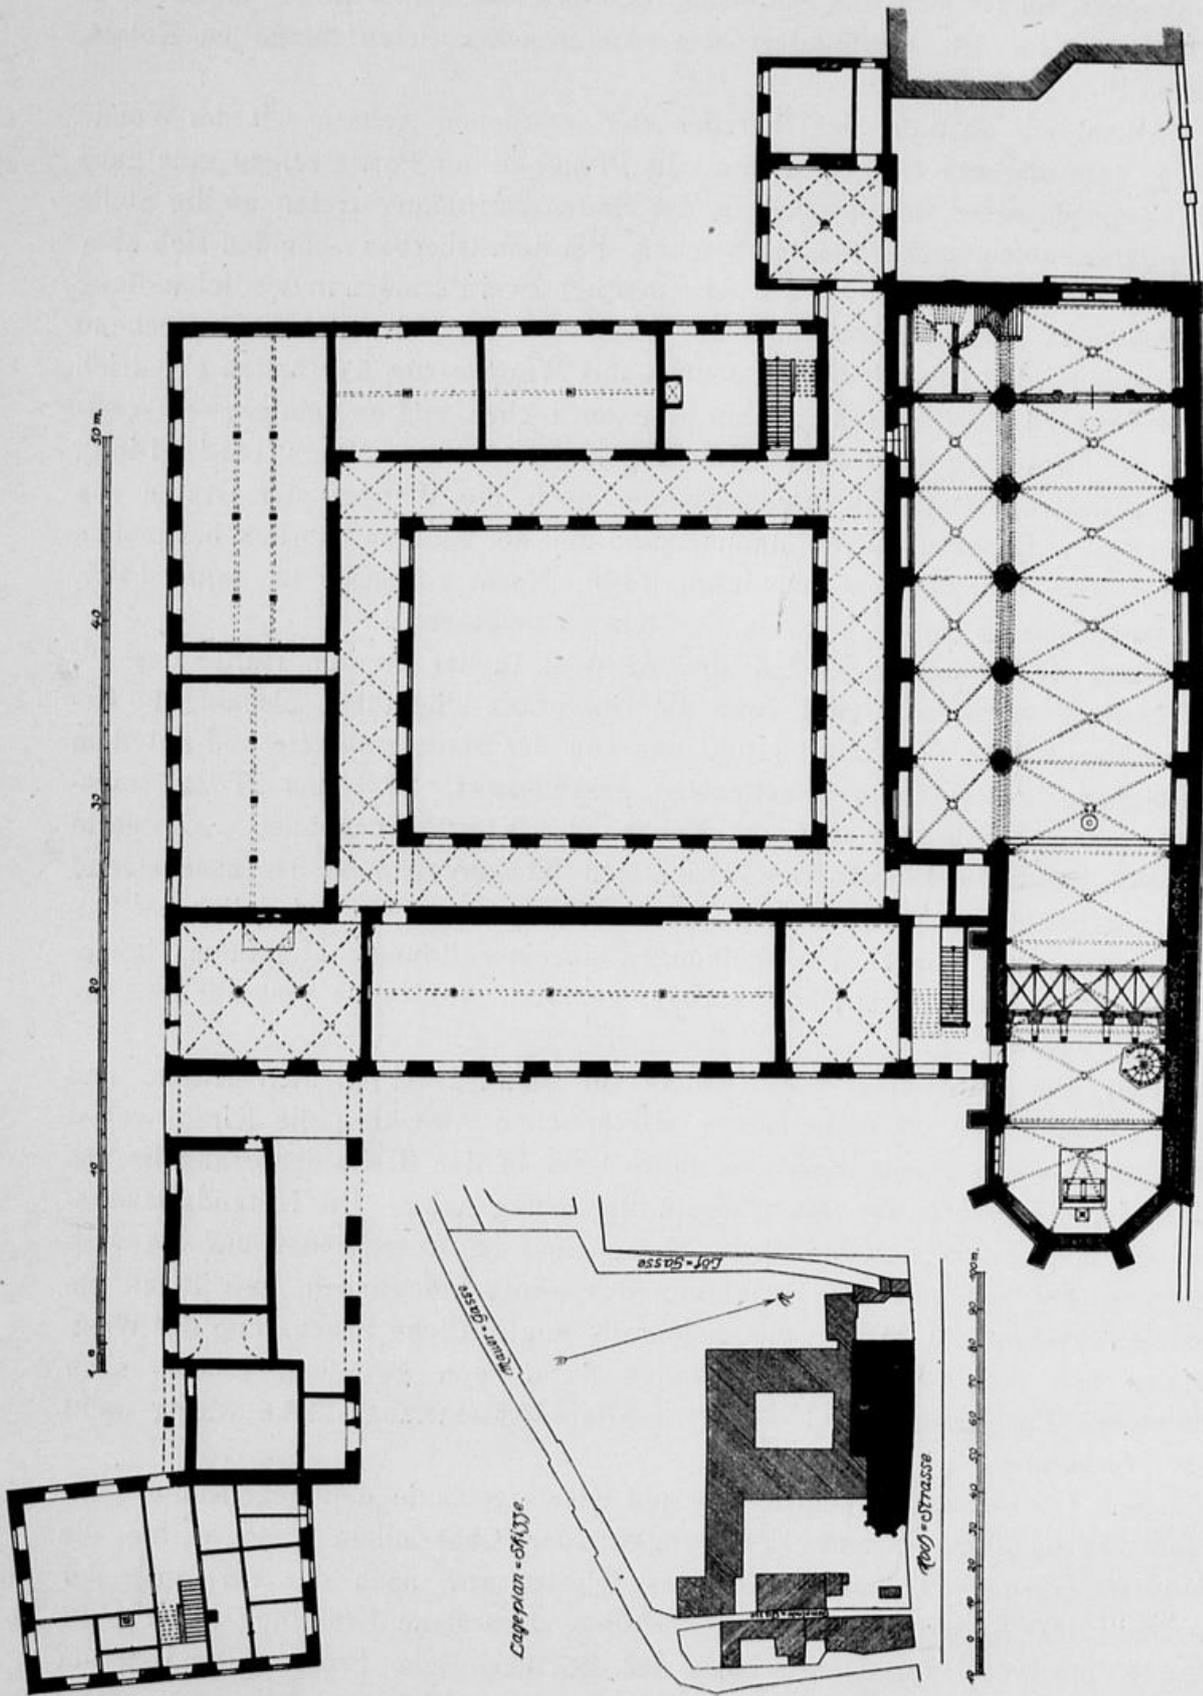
Andernach. Grundriss und Lageplan der evangelischen Pfarrkirche mit den früheren Klostergebäuden.
